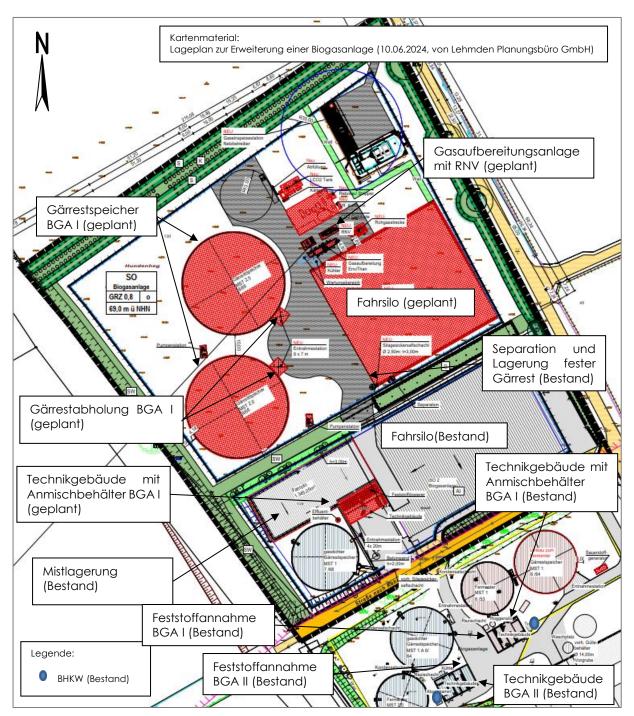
Lageplan der Anlage im geplanten Zustand
